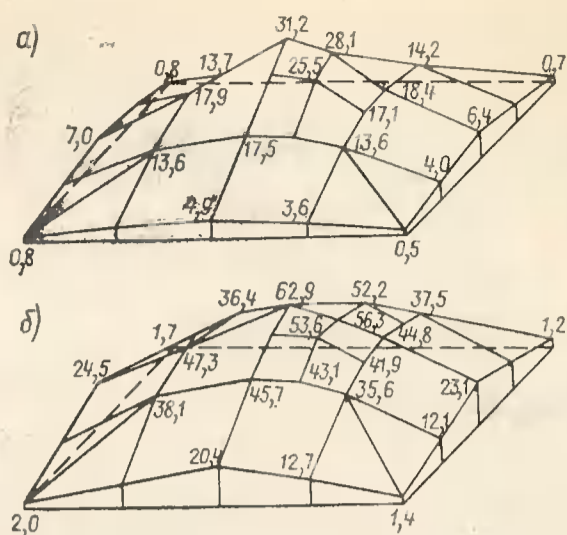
Вертикальные перемещения опытной ячейки шатрового перекрытия при испытательной контрольно-разрушающей нагрузке а — загрузка по первой схеме; б — то же, по второй
